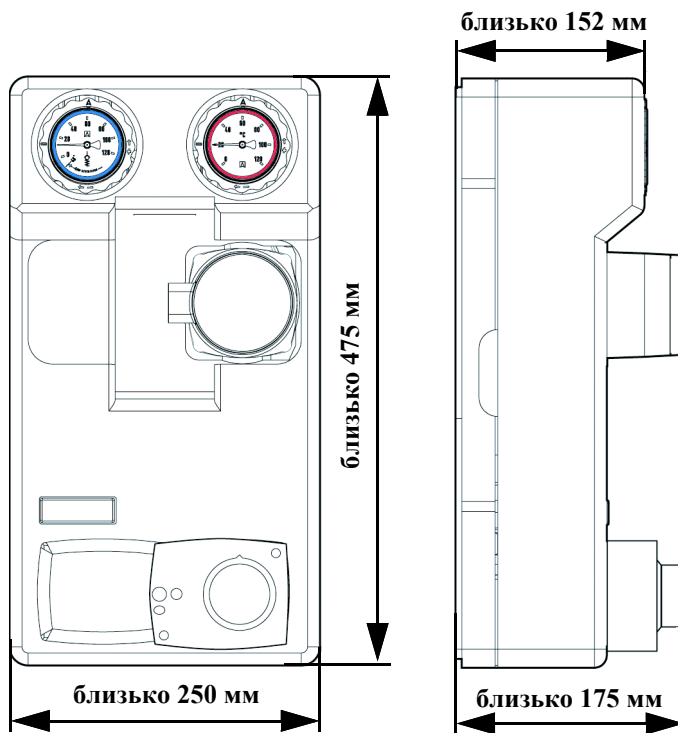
Група PrimoTherm® 180-2 DN25 стандартна версія
